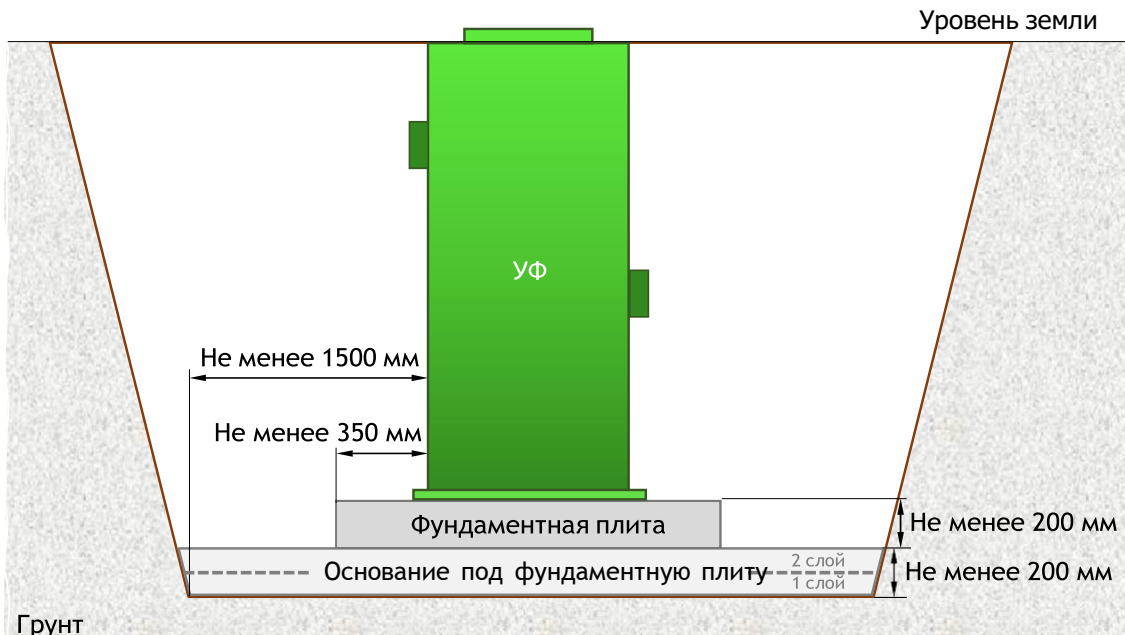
Габариты котлована, основания и фундаментной плиты (вертикальная ёмкость)
